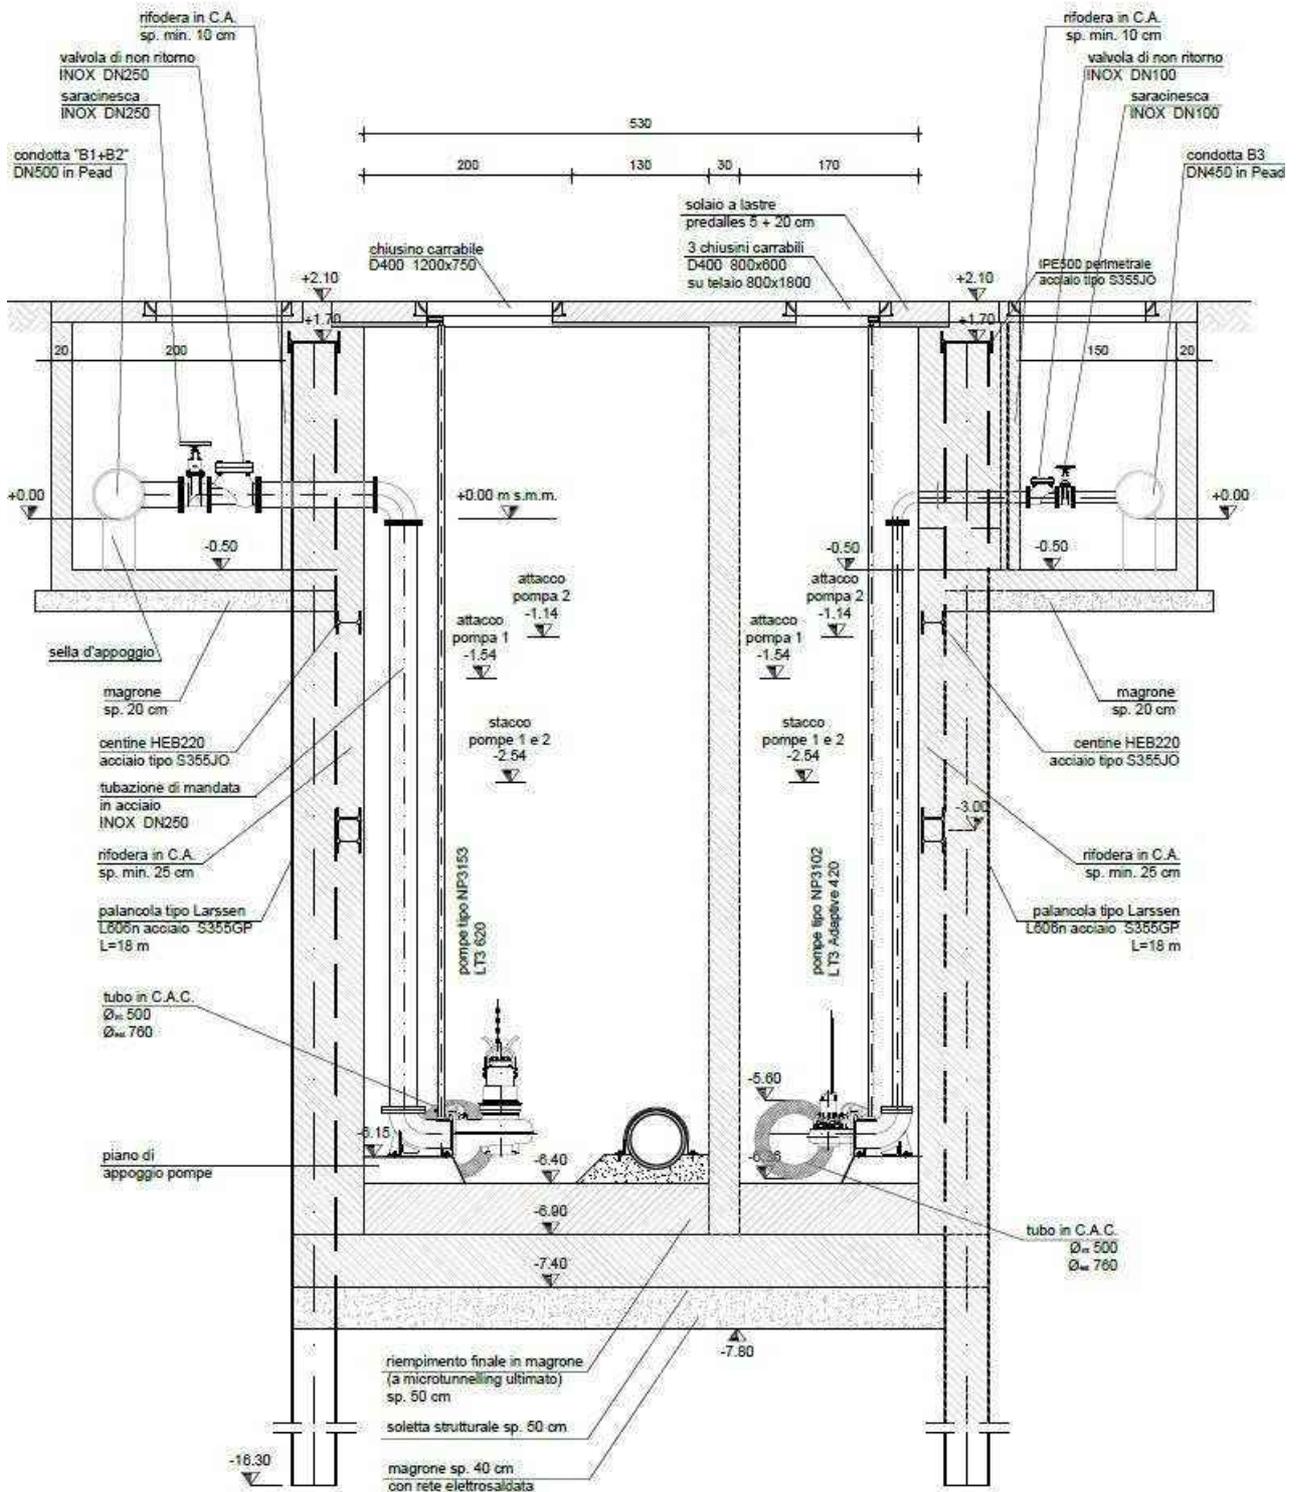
Pianta e sezione del pozzo di arrivo del tratto di microtunnelling
